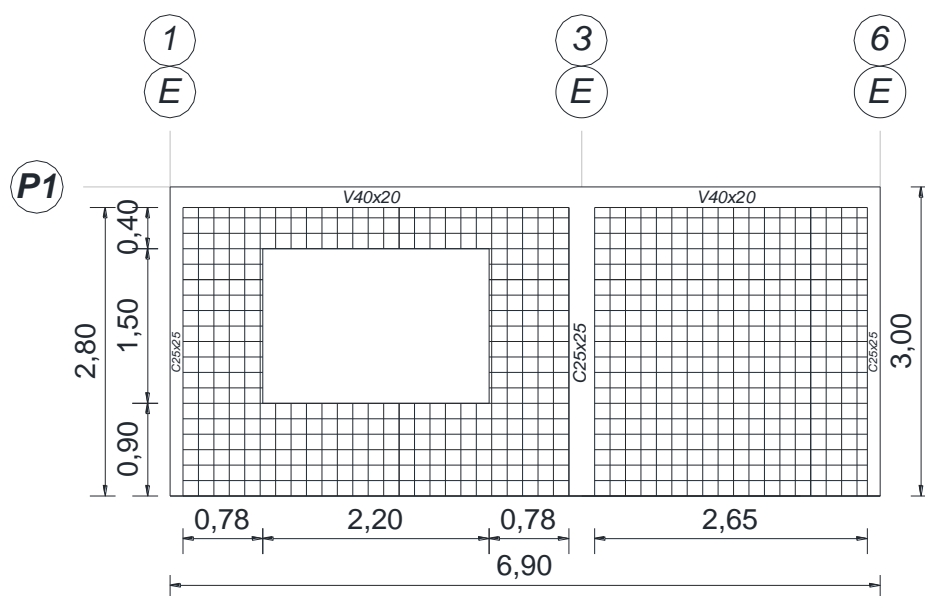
Mampostería Contrachapada – Reforzamiento Estructural.
